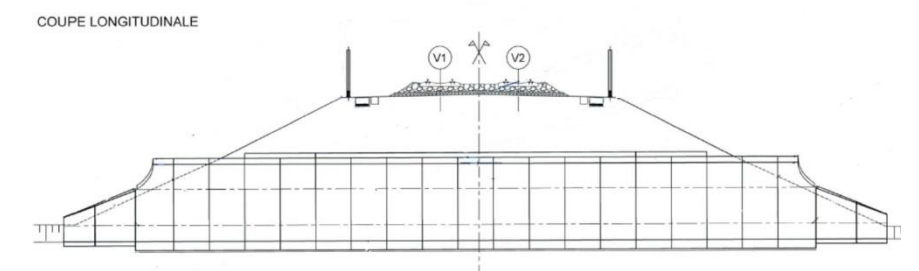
Coupe d'un ouvrage multi-voute (source : INGEROP)
